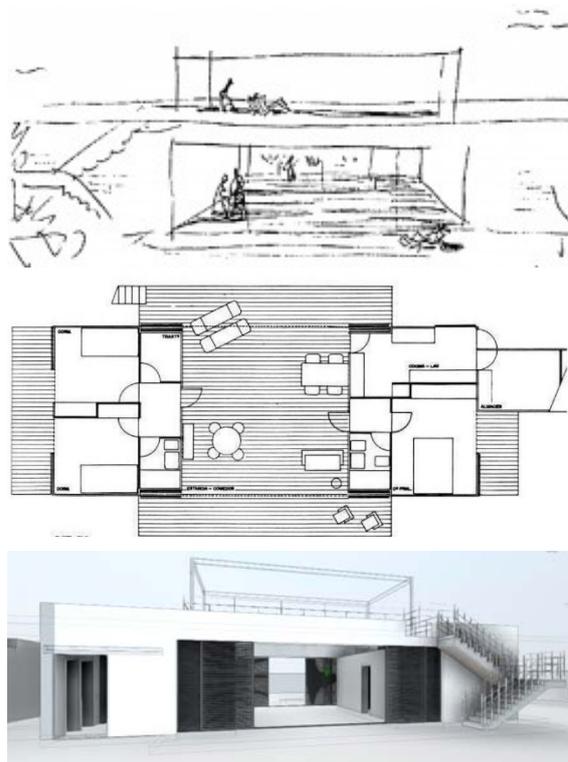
Proyecto de Viviendas en la Bahía de Alcudia 1983\_84 (no construido). Alejandro de la Sota. Croquis y planta originales y vista 3D BIM de los autores
